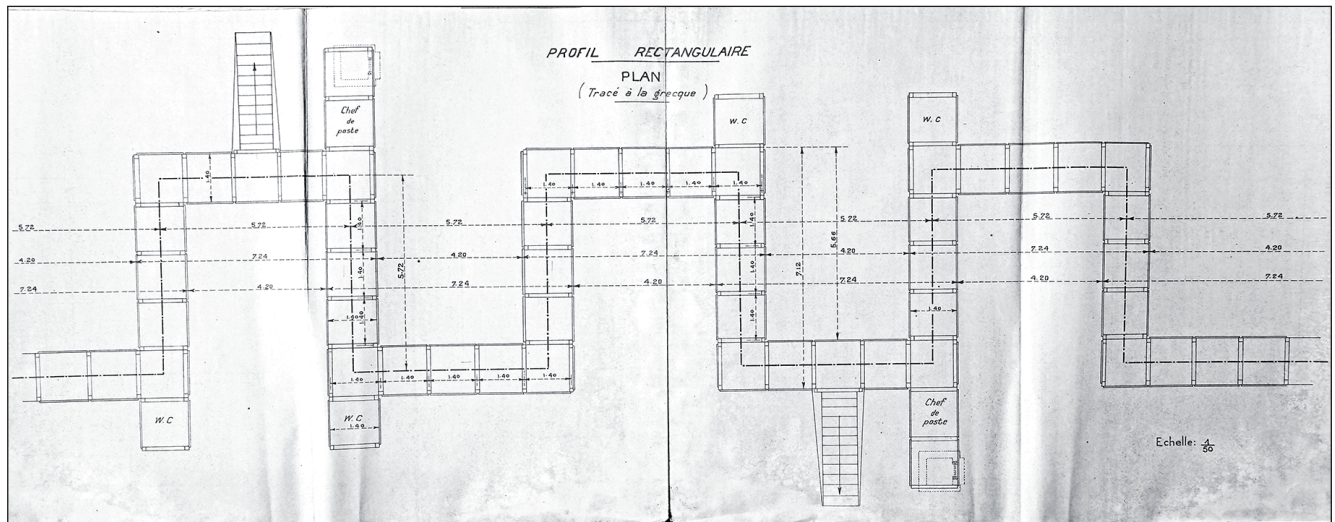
Plan d'un module de tranchée-abri permanente en béton pour Gagny, 1939, Arch. mun. Gagny, boîte 4.
